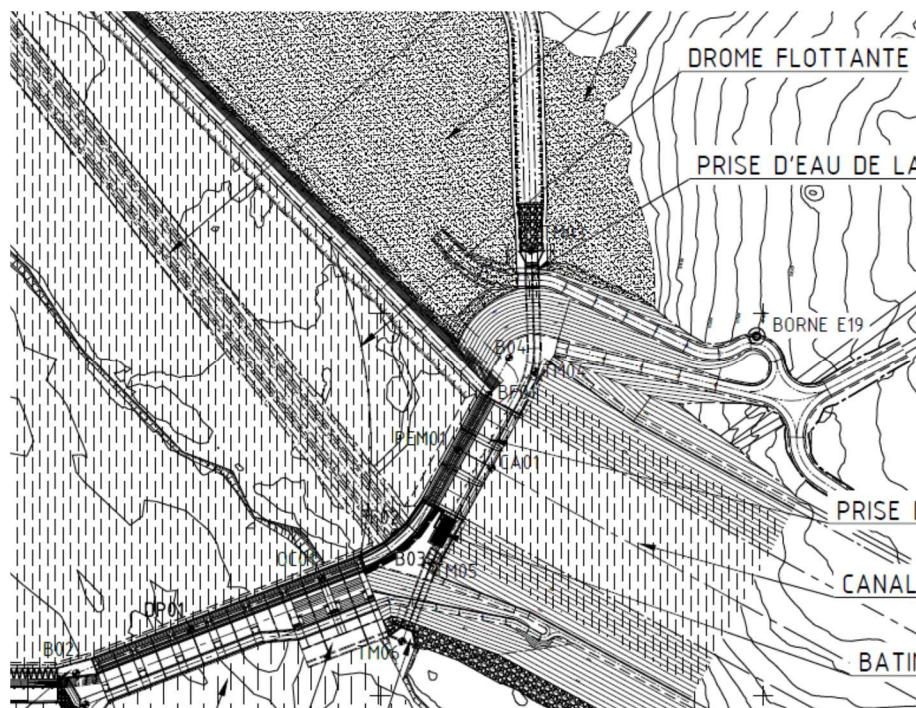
Prise d'eau du canal usinier – protection contre les flottants
